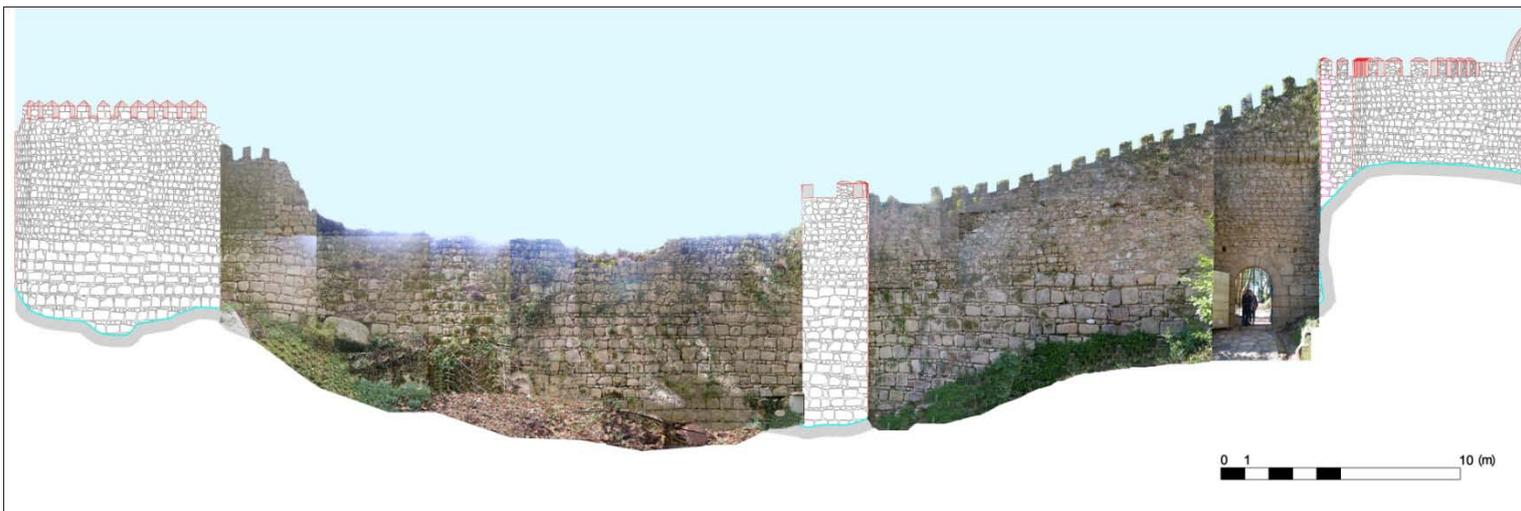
Levantamento fotográfico sobreposto ao levantamento arquitectónico. JMM
